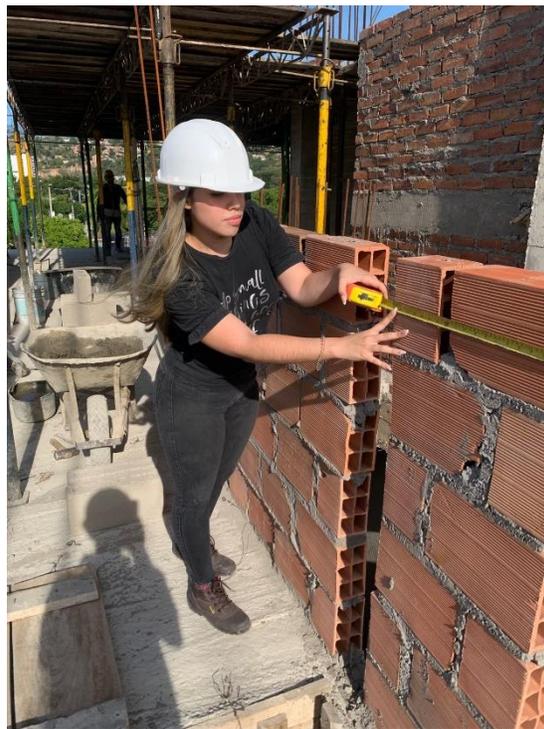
Muro bloque galleta escalera de 0.50m Edificio Wiedii
